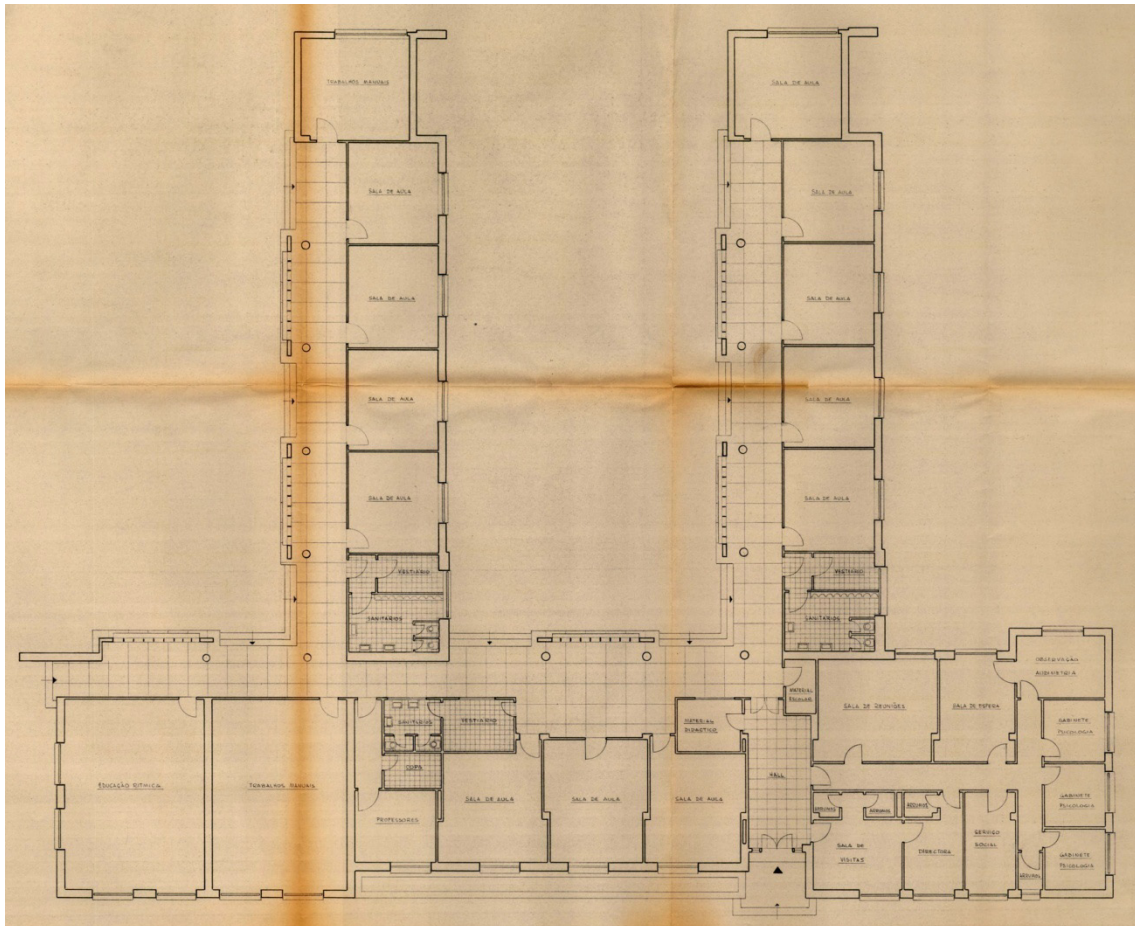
Planta do Bloco de Aulas do Instituto de Surdos de Bencanta.
